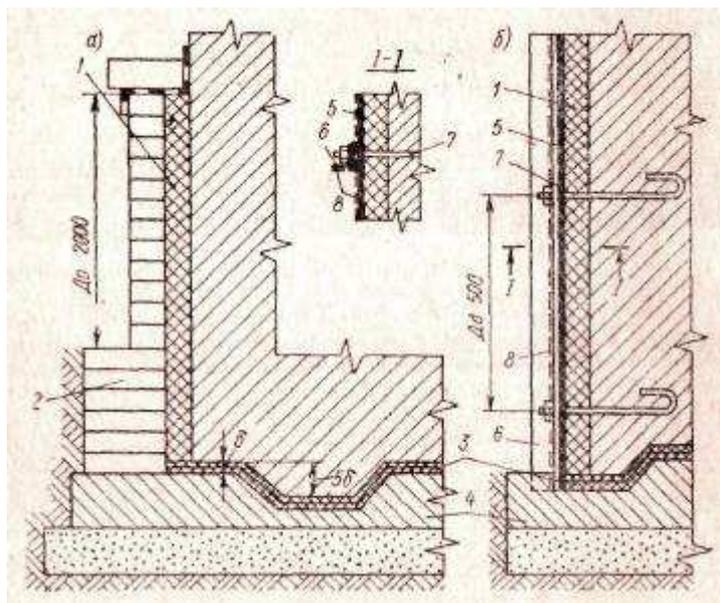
Конструкция асфальтовой литой гидроизоляции и теплогидроизоляции (к п. 3.31)
